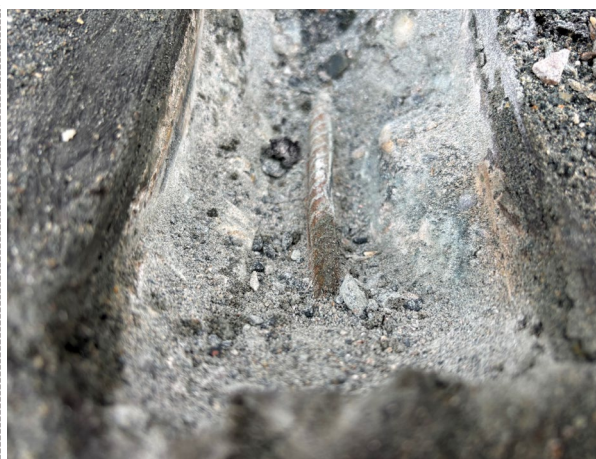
Detail wapening onderzoekslocatie [1]
